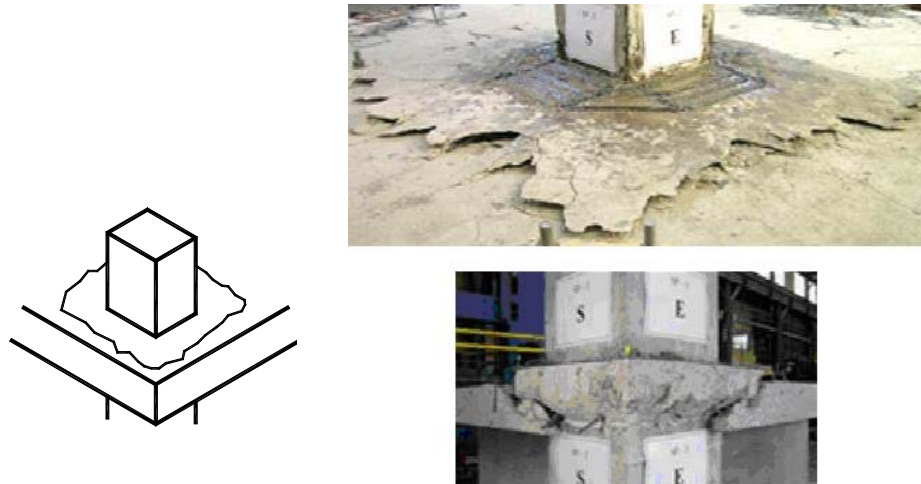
Grietas alrededor de columnas (Widianto y otros, 2006)
